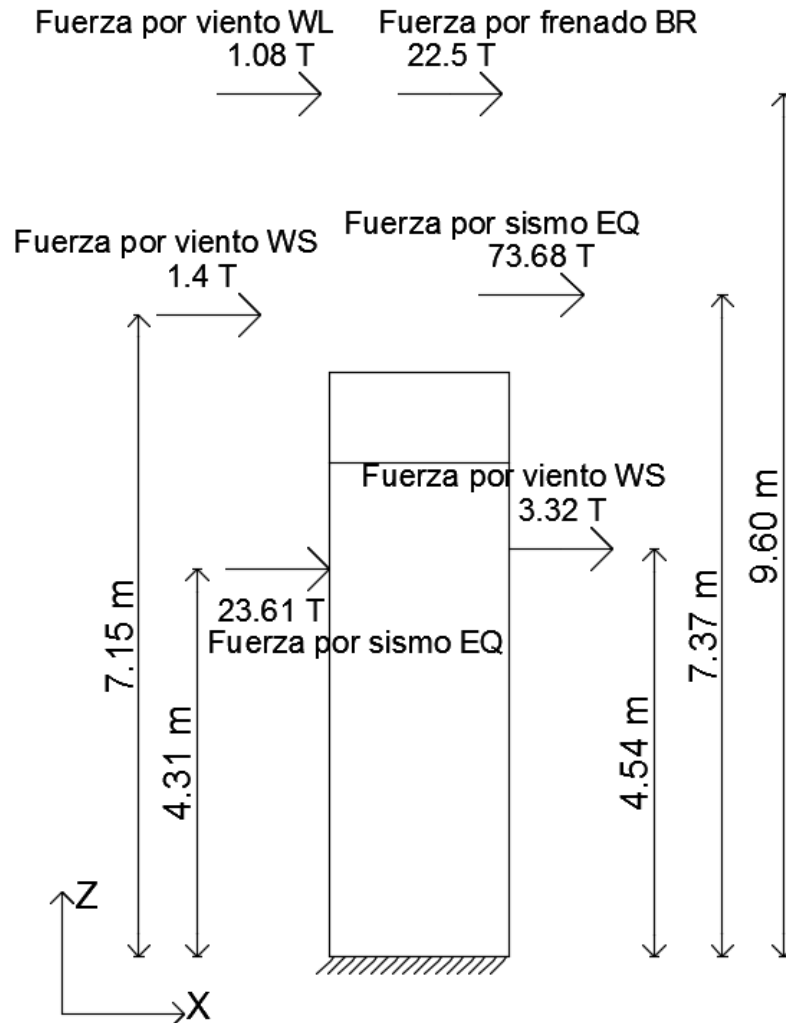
Fuerzas horizontales sobre la pila del ejemplo de puente para un intercambiador en el plano Y-Z
